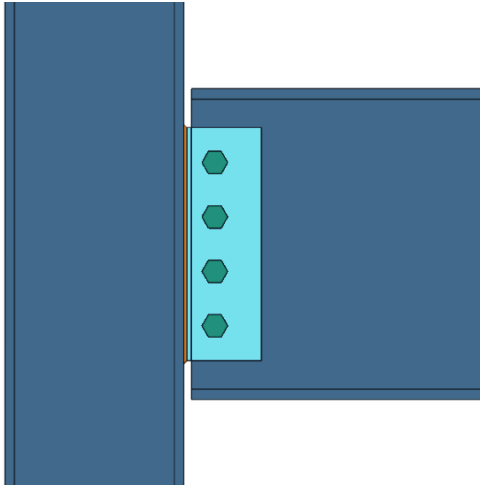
Articulation poteau-poutre par cornières soudés sur la semelle du poteau - vue de côté
